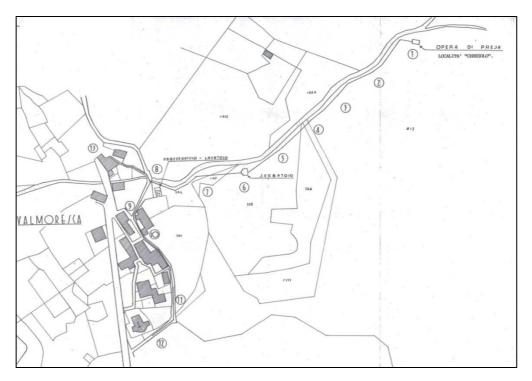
PLANIMETRIA GENERALE ACQUEDOTTO RURALE – FRAZIONE VALMORESCA
